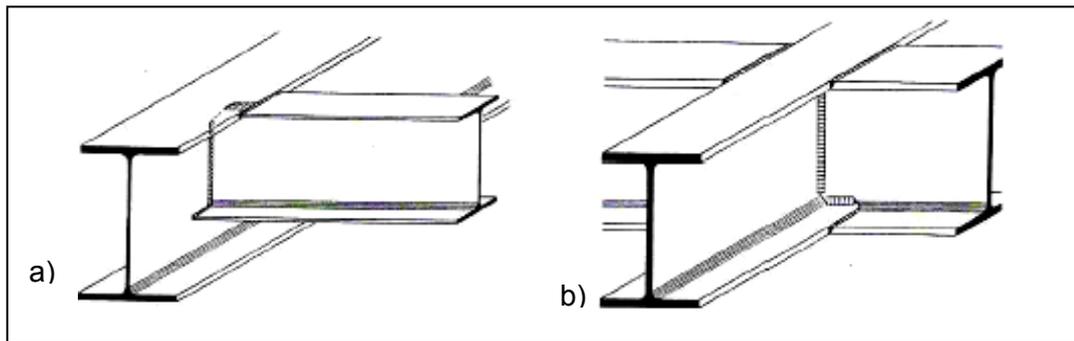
Geschweißter Anschluss, Ausführungsformen, aus [5]
